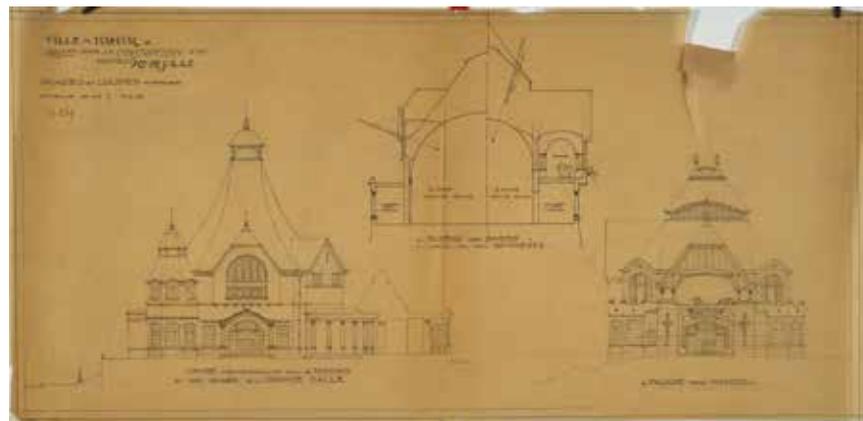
Ville de Namur. Projet pour la construction d'un nouveau Kursaal. Façades et Coupes diverses. Coupe transversale dans le jardin et vue entrée de la Grande salle. Schéma des coupes dans les deux bâtiments. Façade vers Namur, 13 septembre 1909.
